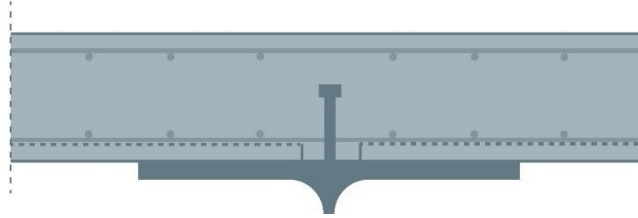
Verbunddecke mit Stahlblech und Ortbetonergänzung
